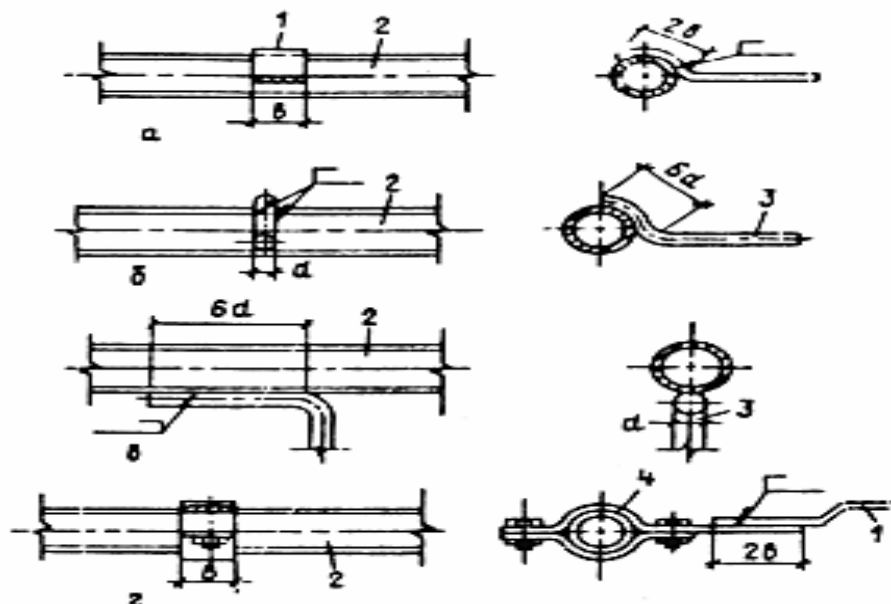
Присоединение заземляющего проводника к трубопроводу сваркой (а-в) и с помощью хомута (г):
